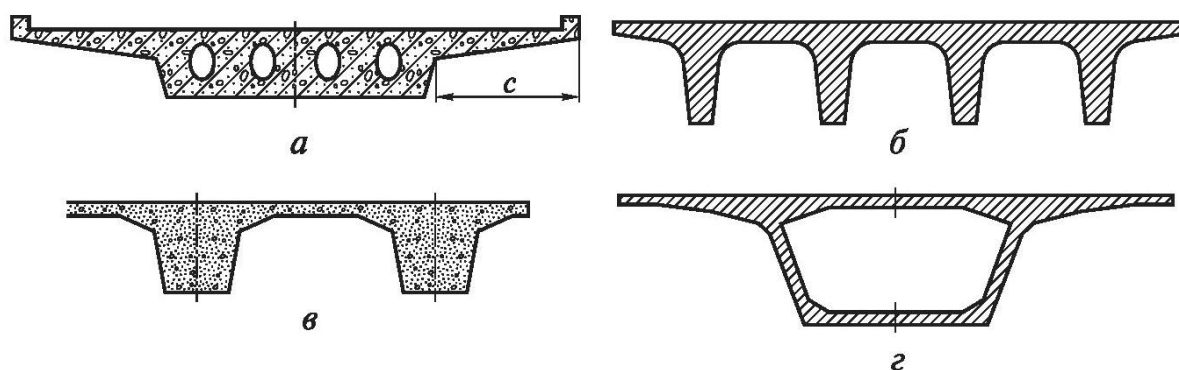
Типы поперечных сечений балочных железобетонных пролетных строений: а - плитное; б - ребристое; в - плитно-ребристое; г – коробчатое
